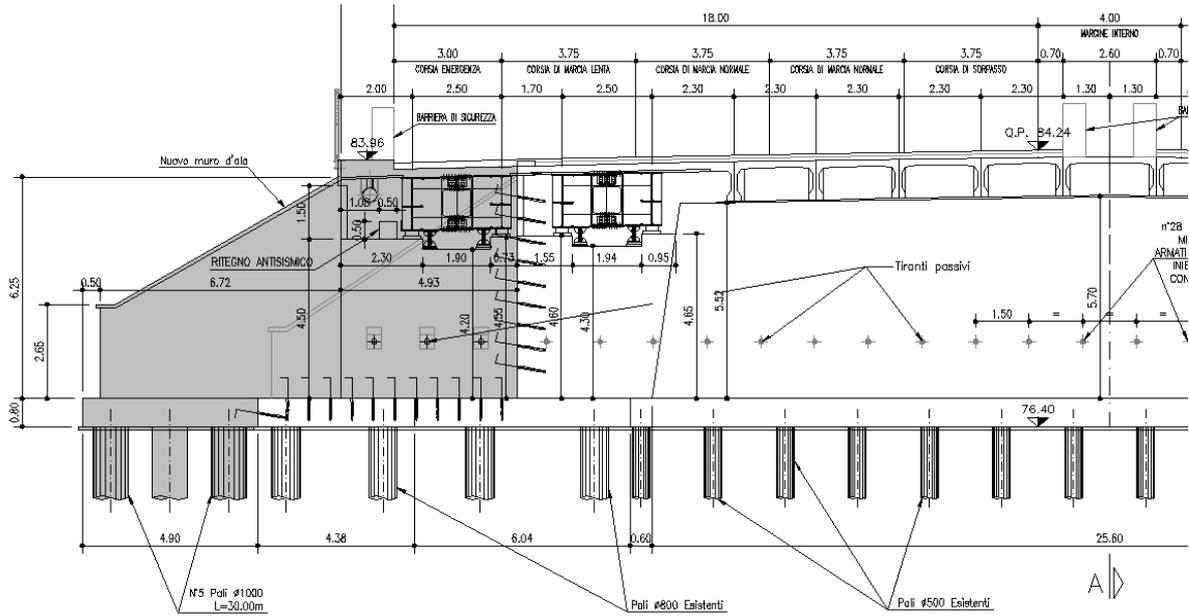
Ponte sul Lambro: mezza vista frontale delle spalle
